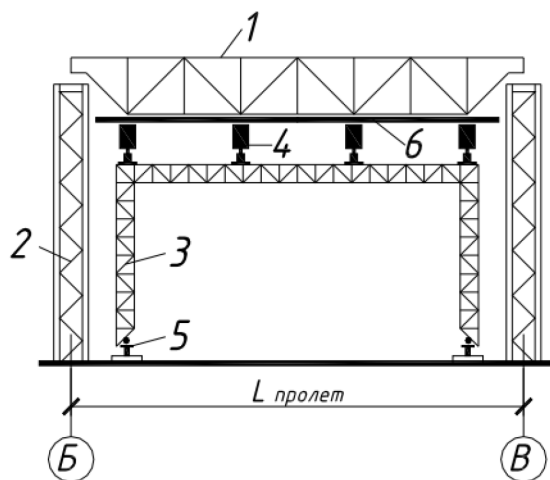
Схема монтажа блоков покрытия высоким установщиком:
